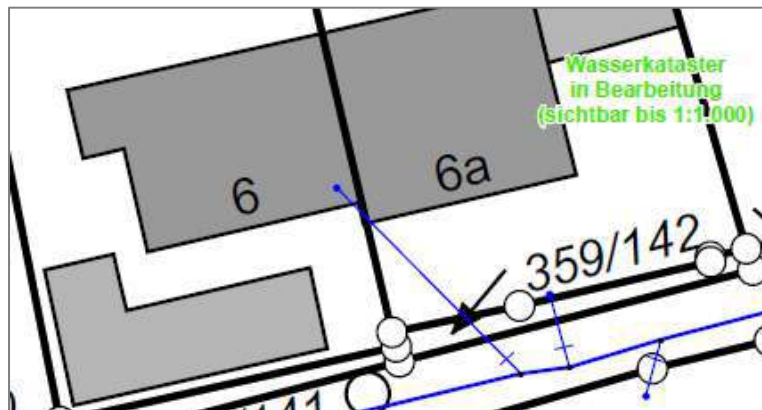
/ Quelle: Ausschnitt Lageplan Wasserverband
